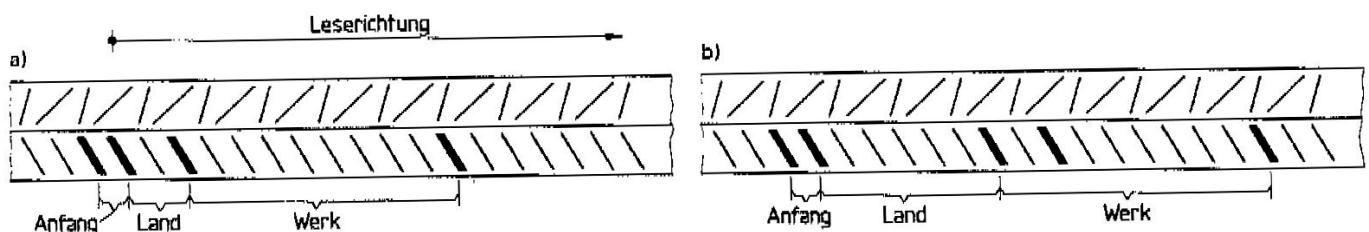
Kennzeichnung von Betonstabstahl BSt 500 S
